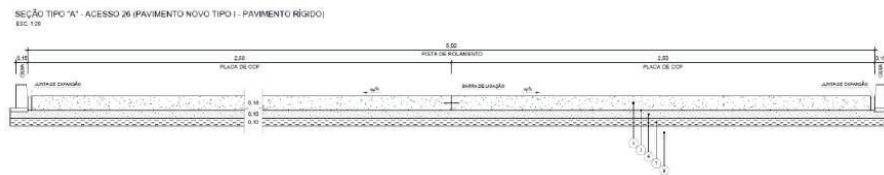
Seção Típica Acesso 26 cota Est. 100 até 104 em pavimento rígido.
